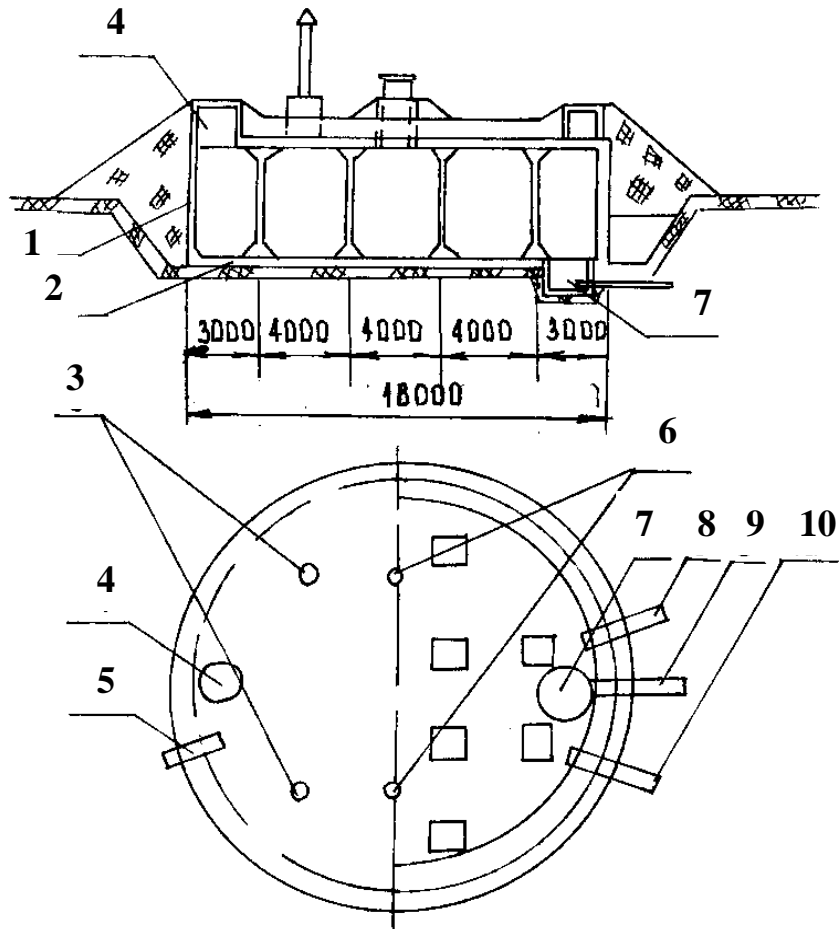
Резервуар для чистой воды: 1 – монолитная стена; 2 – днище; 3 – вентиляционные колонки; 4 – люк-лаз; 5 – подающая труба; 6 – световые люки; 7 – грязевой приямок; 8 – отводящая труба; 9 – грязевая труба; 10 – переливная труба
